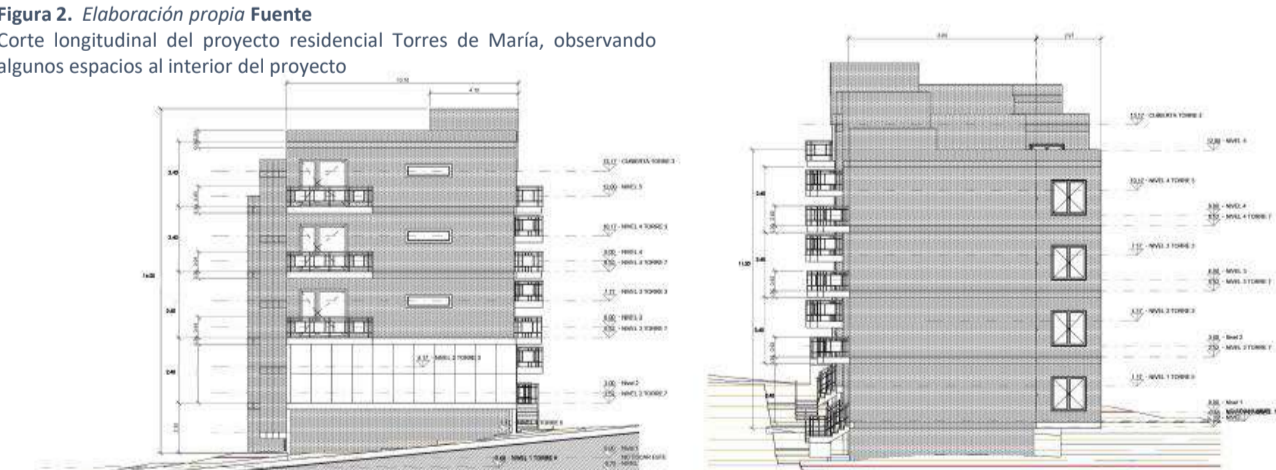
Elaboración propia Fuente. Fachada Este y Oeste proyecto residencial Torres de María
